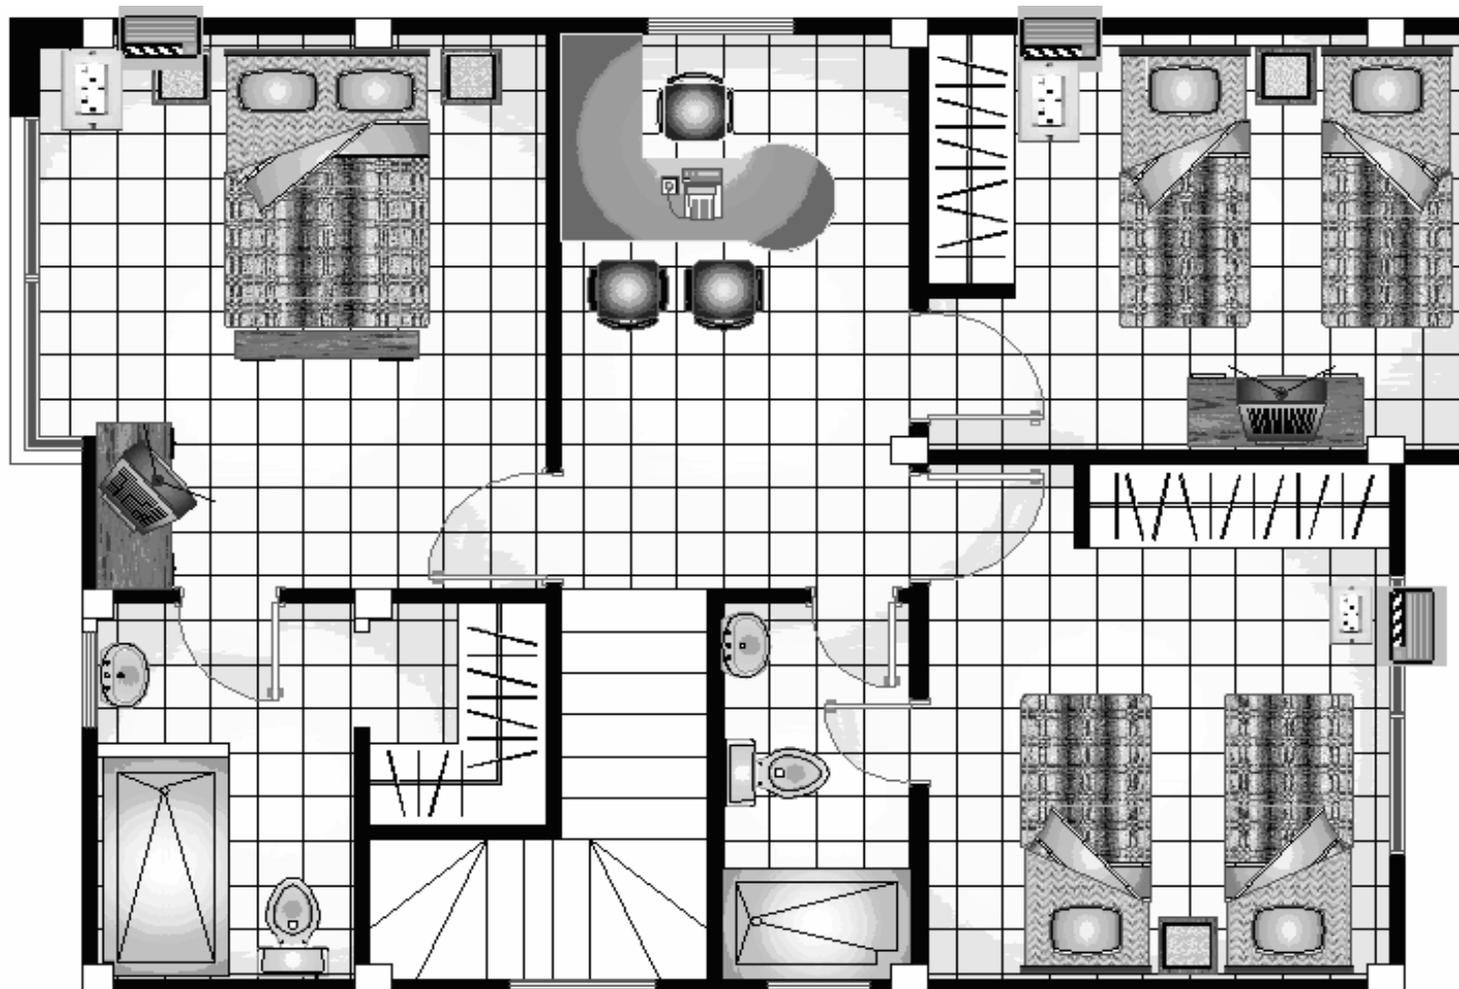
Sistema de Climatización, Planta Alta, Plano Arquitectónico.
